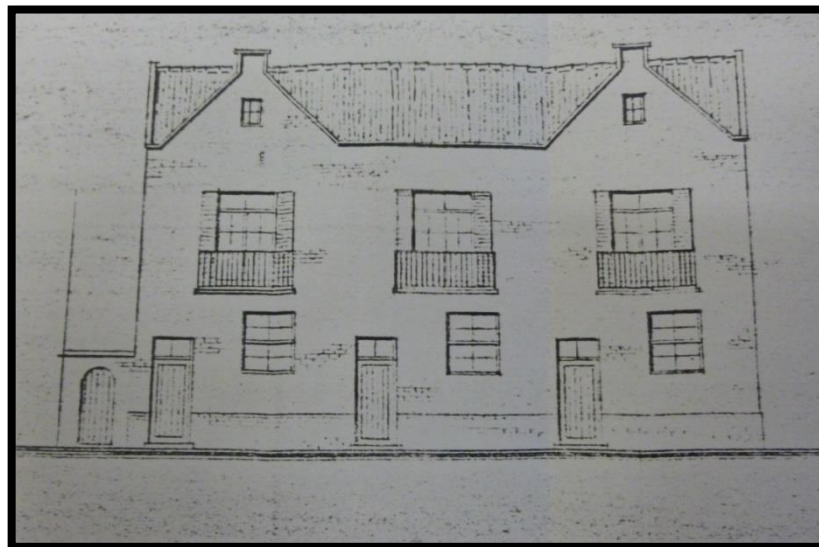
Fachada voltada para a Rua Marechal Hermes da Fonseca. Nota-se que diferentemente do primeiro projeto, a fachada foi modificada e não há presença do armazém e de ornamentos, sendo este o projeto realizado. Fonte: Processo N° 1982 - 0.022.565-8/ N° de capa: 0.074.953/54
